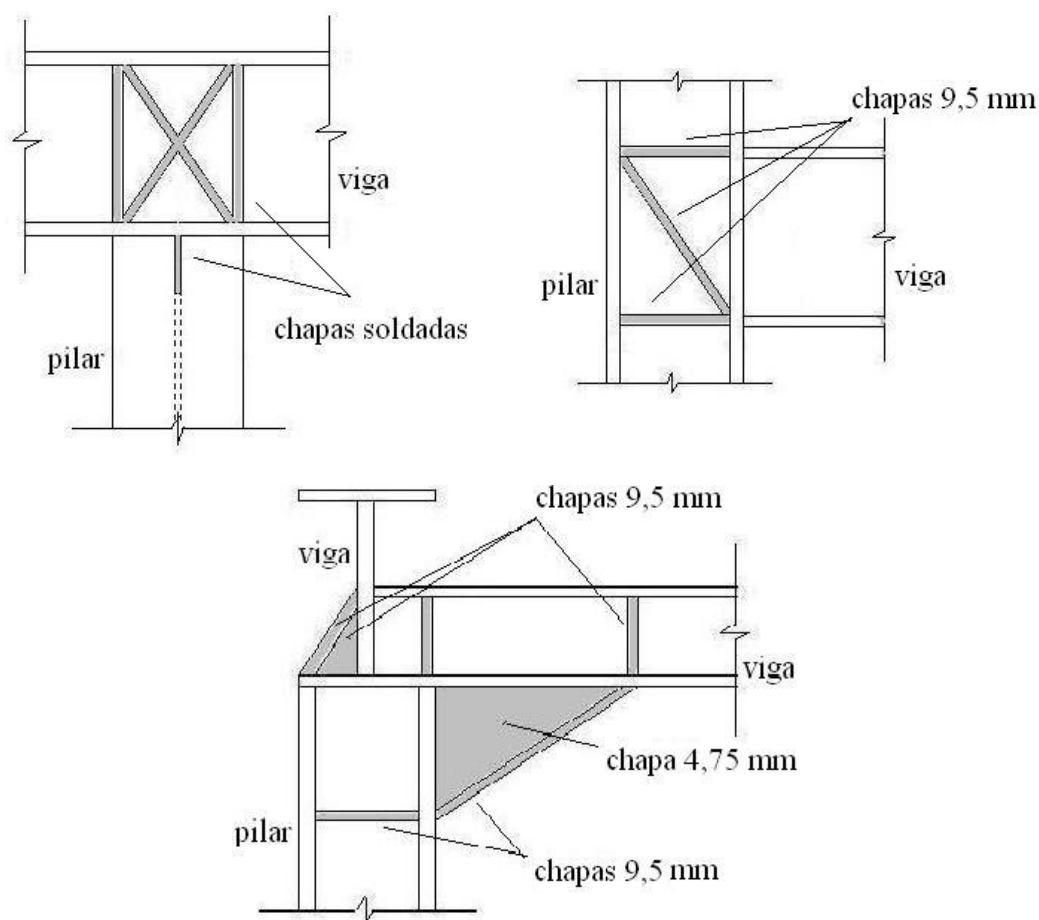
Esquemas de reforços de ligações vigas-pilares por meio de chapas soldadas
